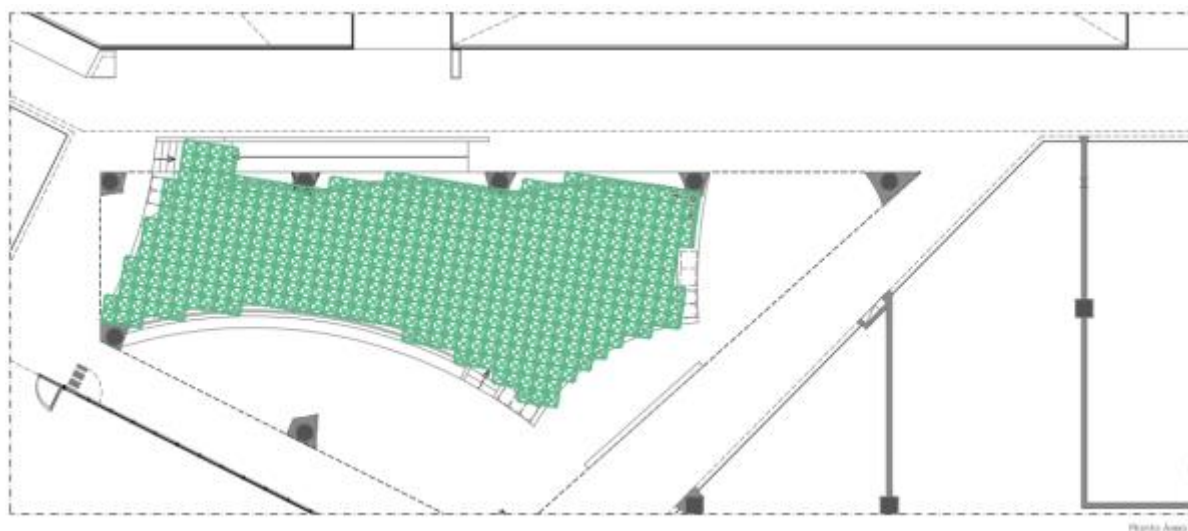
Planta de implantação do Sistema Cupolex na Área 3 [Fonte: Ref. Desenho PE-FC-19; Autor: Atelier NiNi Andrade Silva]
